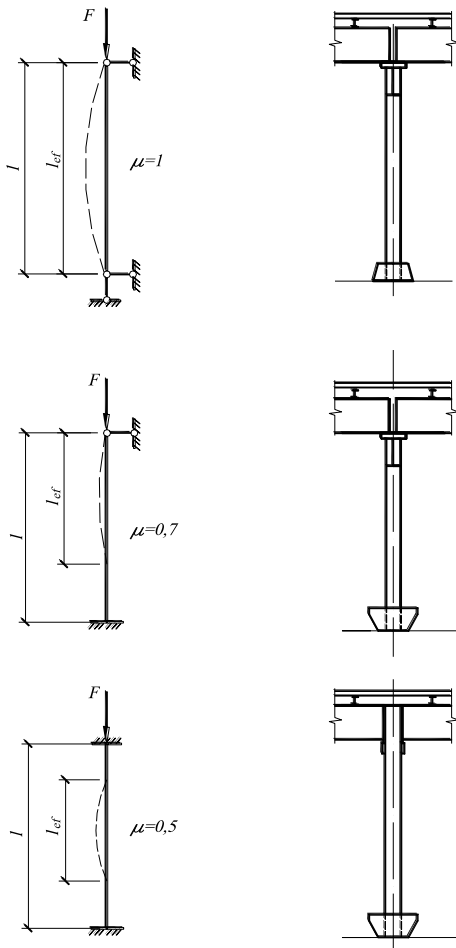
Схемы для определения расчетных длин центрально-сжатых колонн балочных клеток
